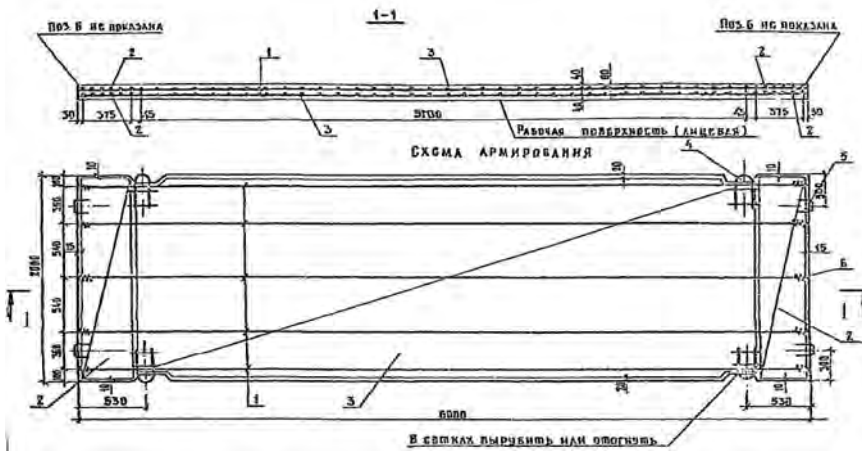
Опалубочные размеры и схемы армирования плит железобетонных преднапряженных по серии БЗ.503.1-1.
